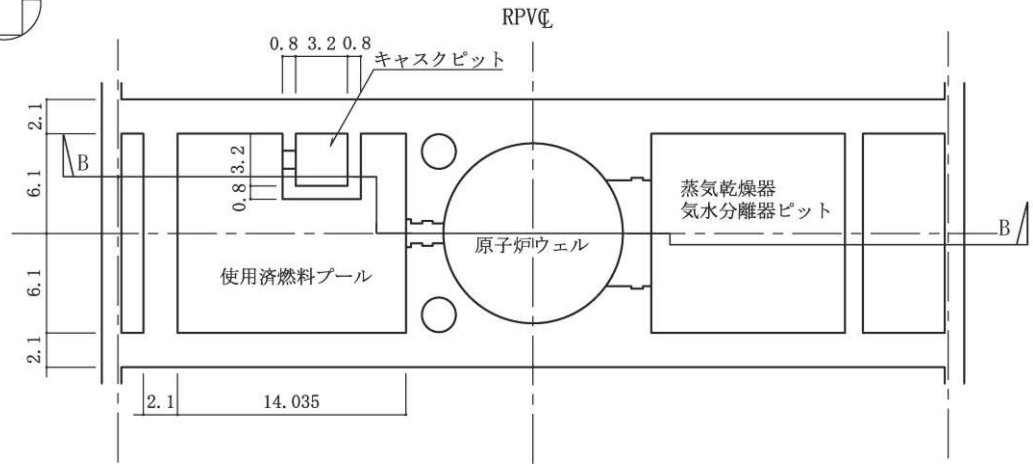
使用済燃料プールを含む原子炉建屋の概略平面図 (O. P. 33.2m)
